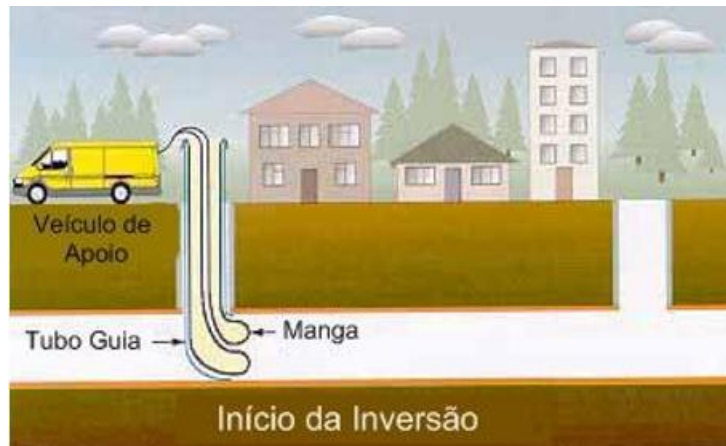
Construção do poço e aplicação do tubo guia e da manga (16)
